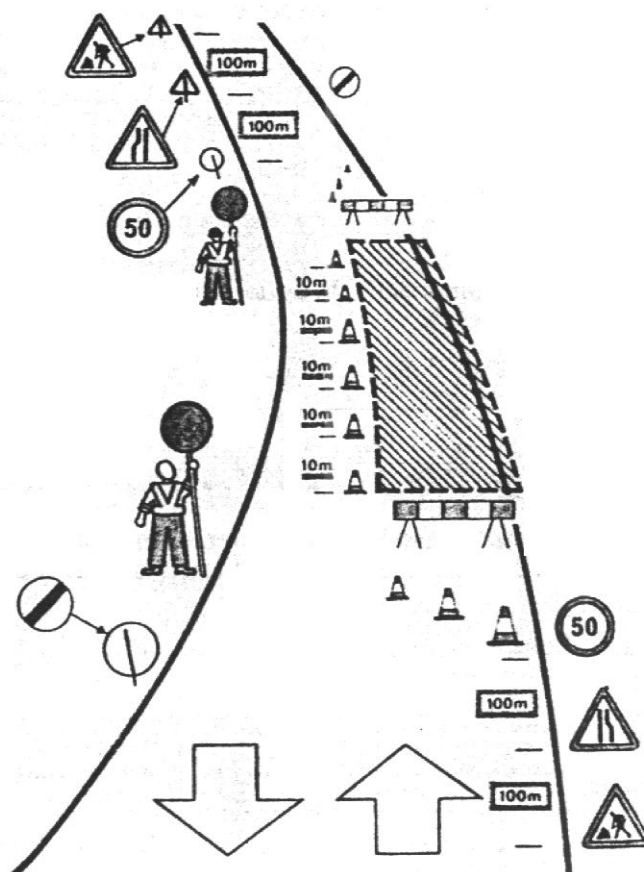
Disposición de Señales Temporales en la reparación de calzadas de concreto.
